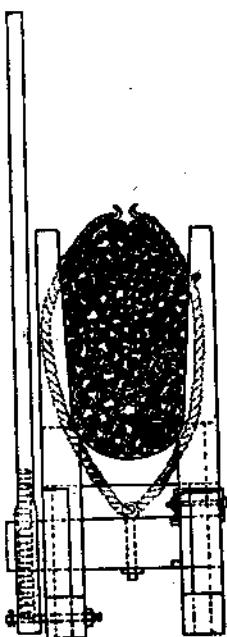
Станок для свалки хвороста. Поперечный разрез.
